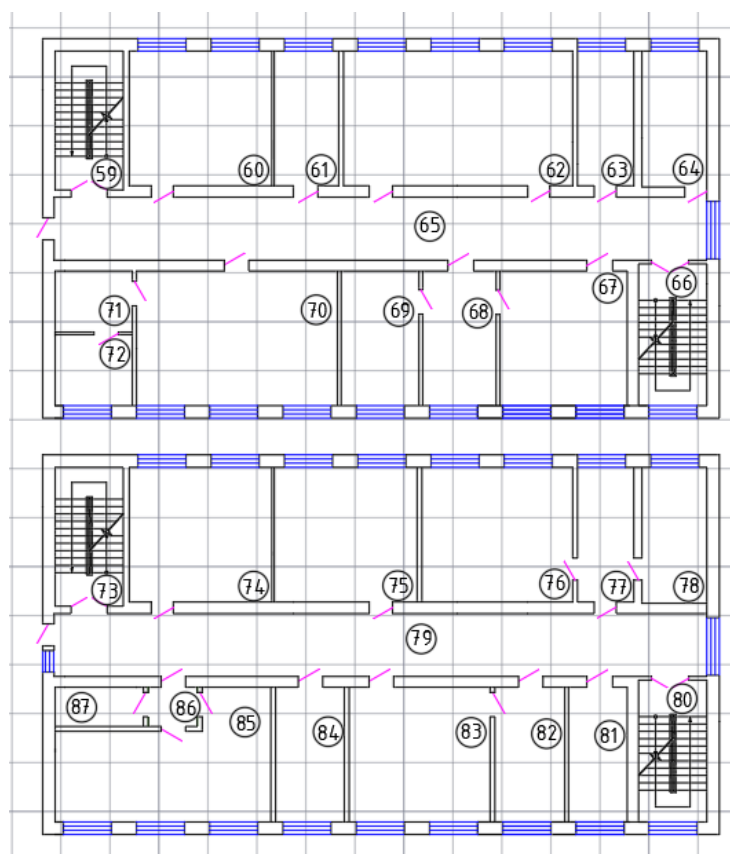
Загальний план лівого крила корпусу №2 ЛНТУ 3 і 4 поверхи
